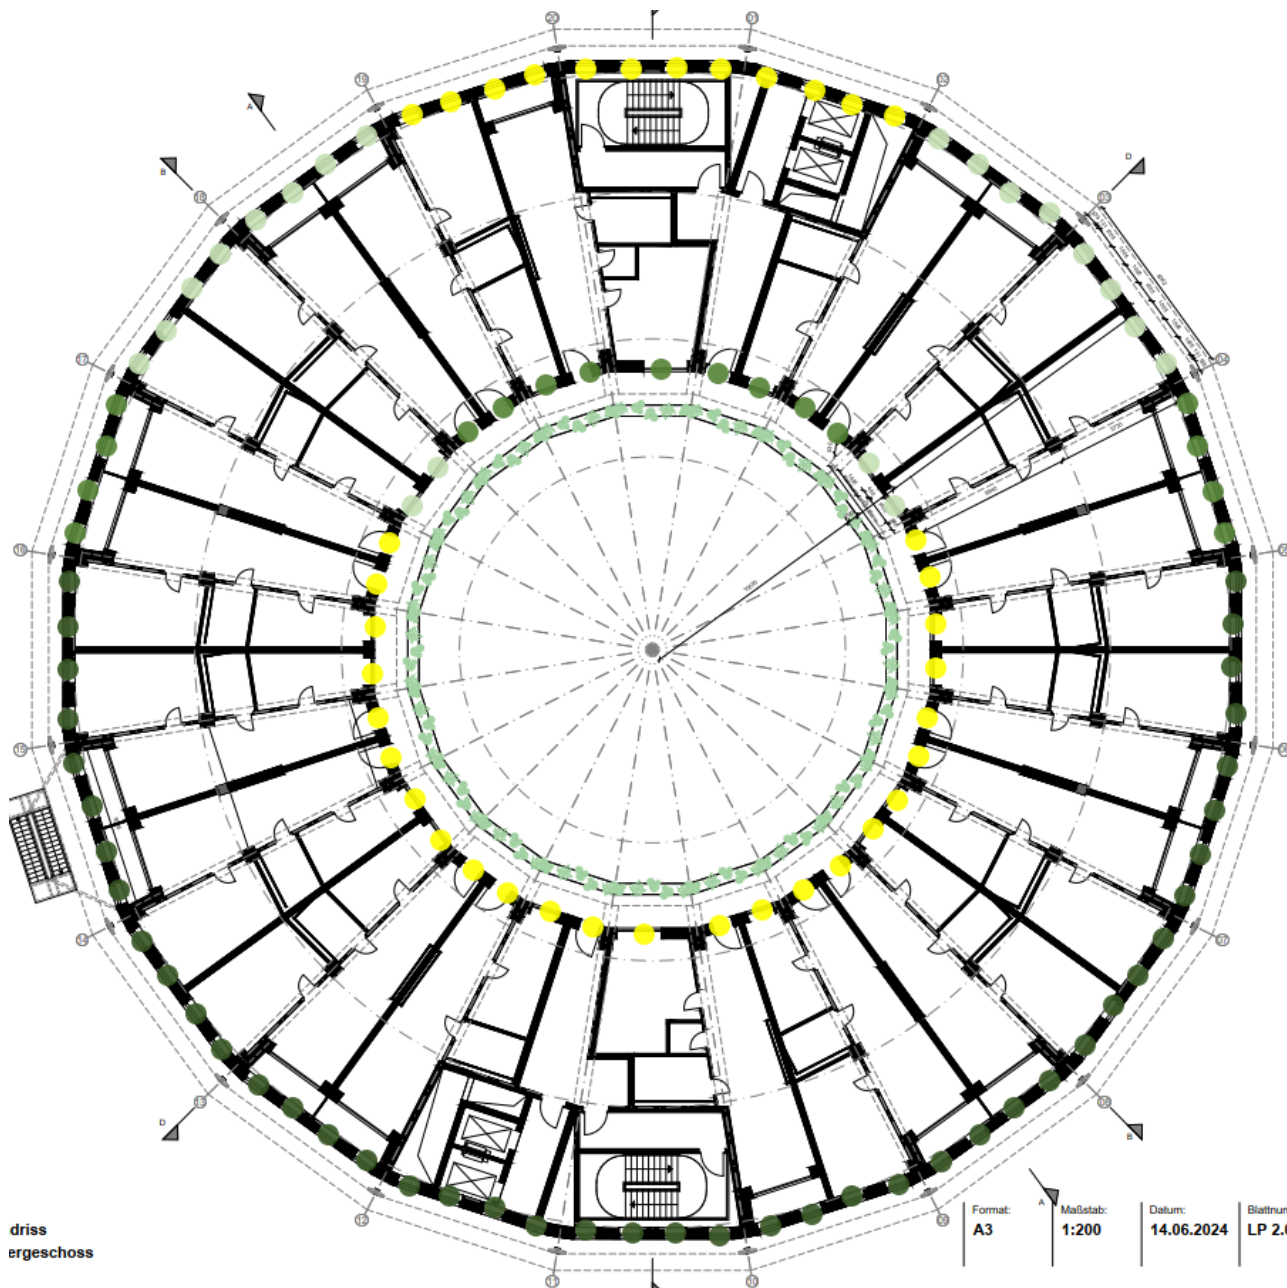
Darstellung der Ergebnisse auf den Grundrissen, 8. Obergeschoss
